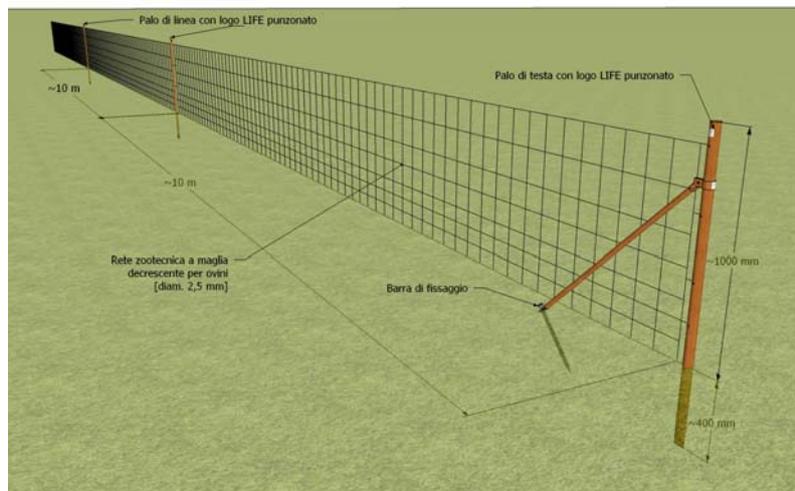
Schema di installazione della recinzione a rete fissa con angolo con doppia controventatura.
